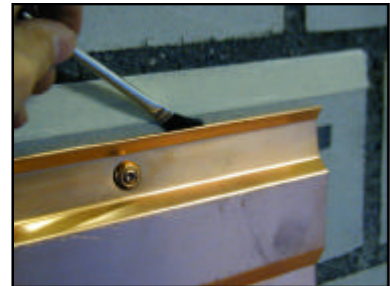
Anbringen eines dem Untergrund angepassten Voranstriches. Trocknen lassen.
